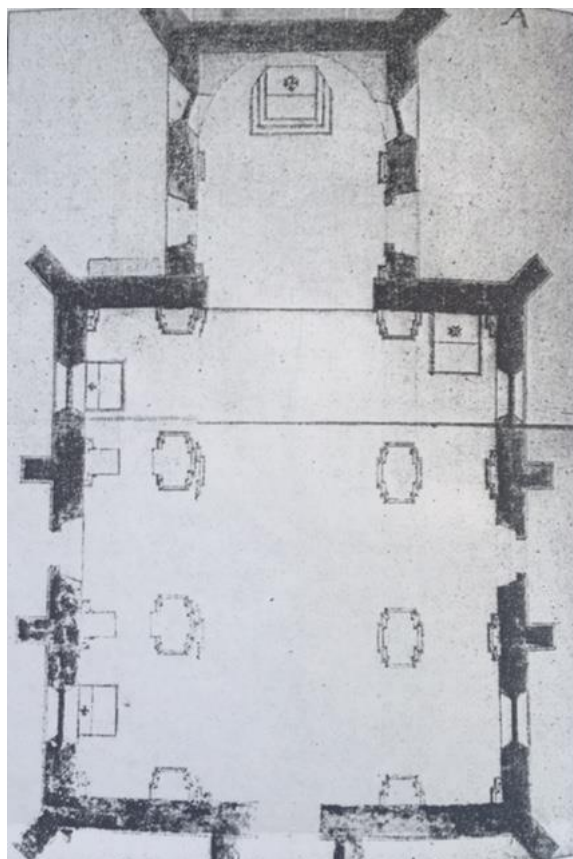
St. Stephanskirche in Krakau, Grundriss. Der Plan befindet sich im staatlichen Archiv in Krakau.
